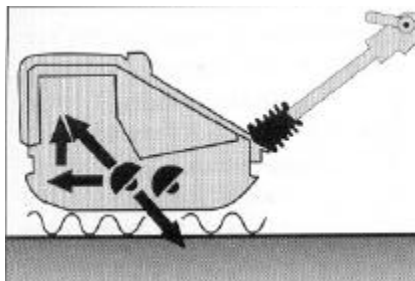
Plancha vibradora con excitador central y de marcha reversible
